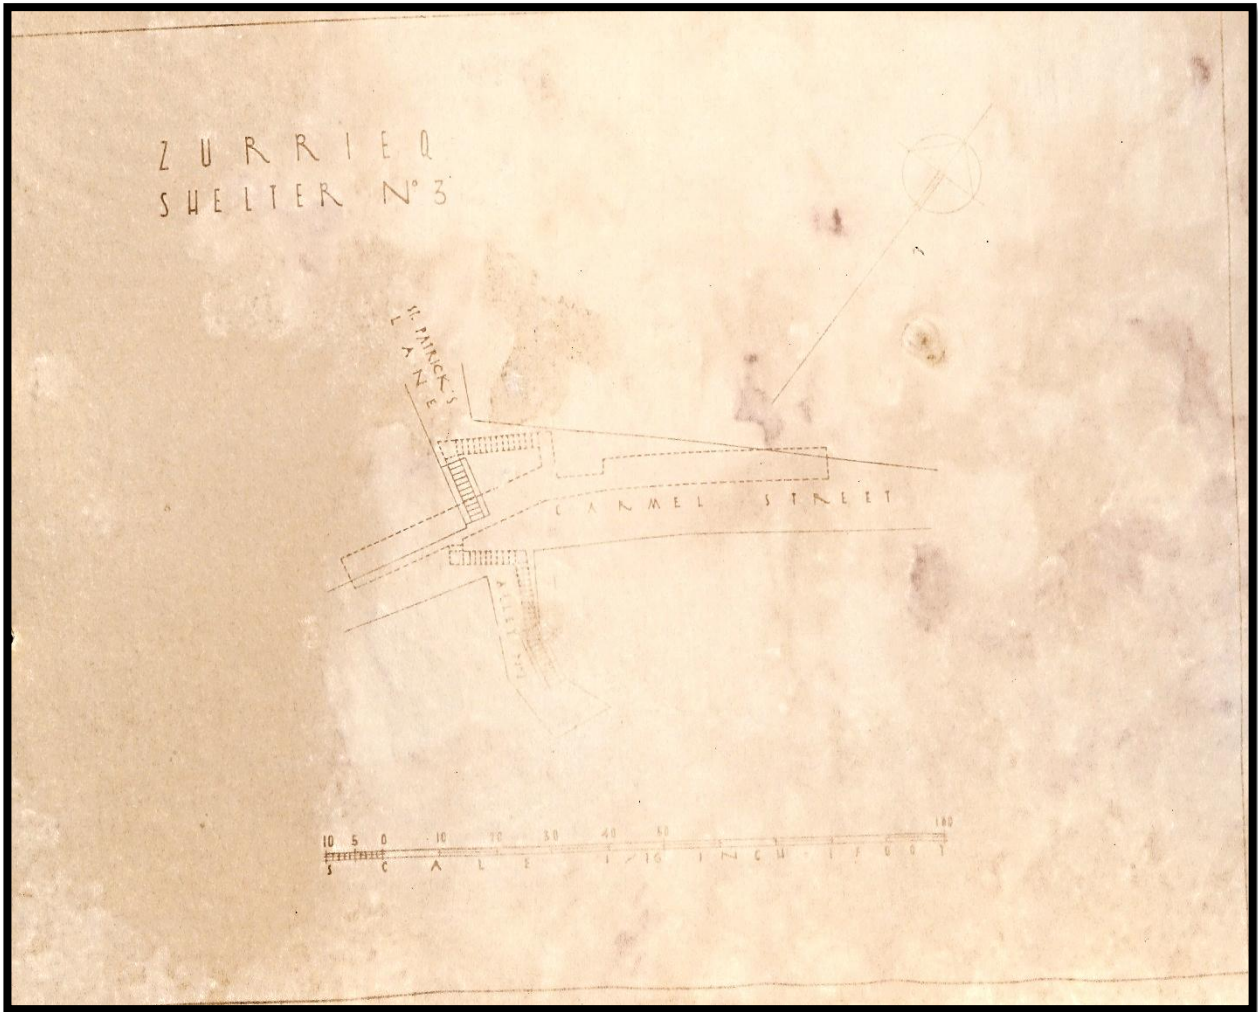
Planta do Abrigo nº3 "St. Patrick's Lane – Carmel Street – Alley nº1."
